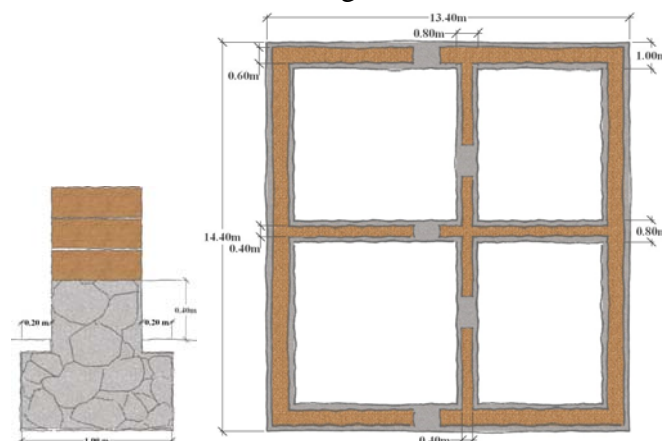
À esquerda, corte da fundação e embasamento e, à direita, planta de fundação
